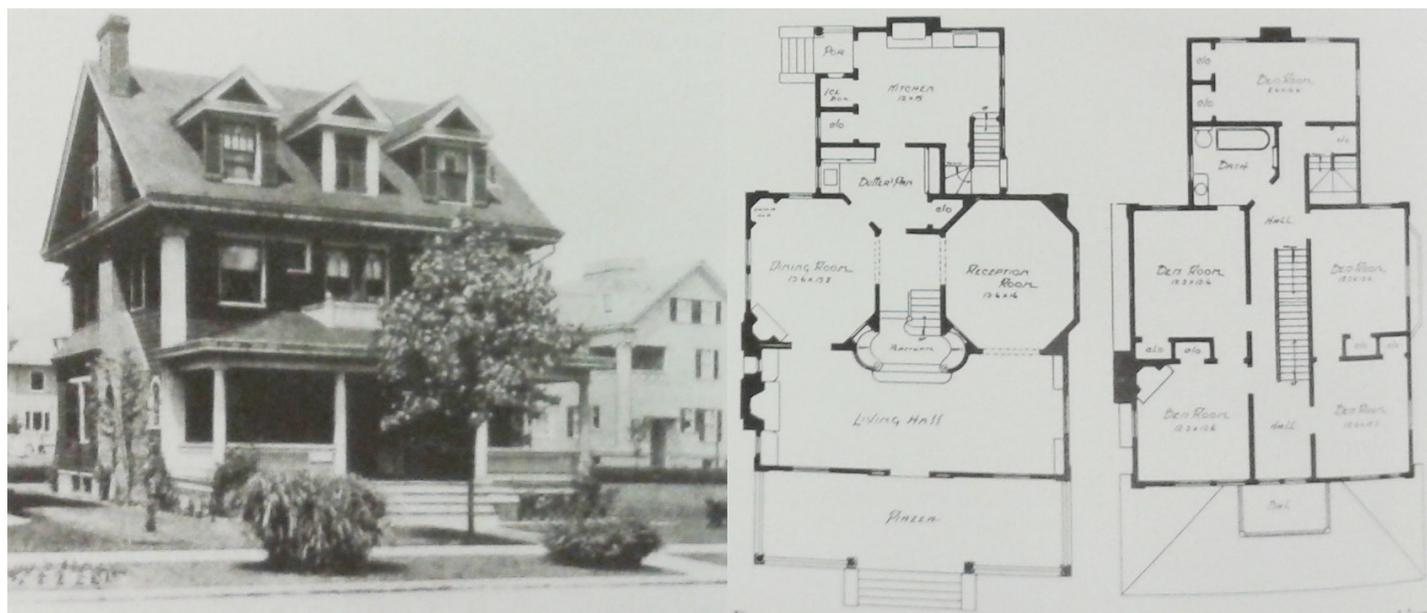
Vista y plantas de una vivienda unifamiliar aislada en Prospect Park South, Brooklyn, 1902. Fuente: *New York 1900: metropolitan architecture and urbanism, 1890-1915, 1983
